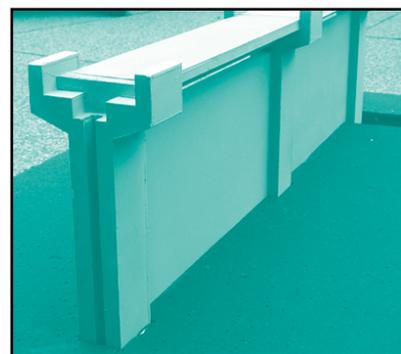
Maqueta de muro de hormigón armado prefabricado para dividir estanques con invernaderos
